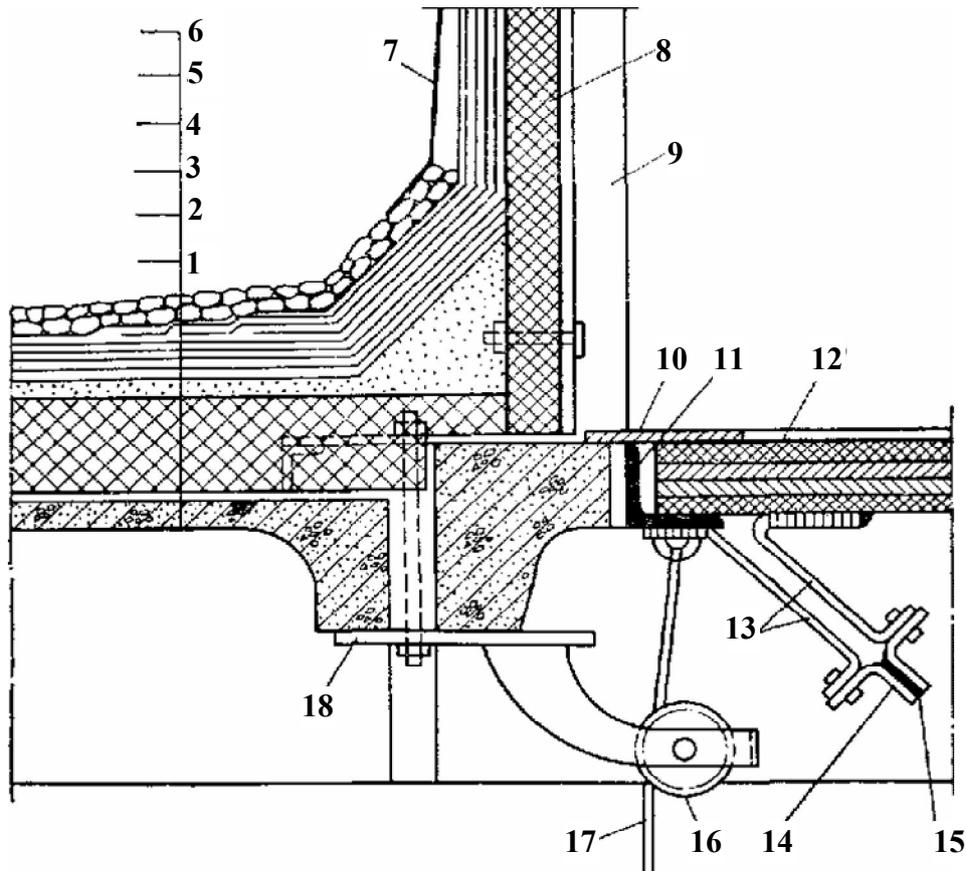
Деталь автоматичного пристрою: 1 – залізобетонна плита покриття; 2 – пароізоляція; 3 – утеплювач; 4 – шар, що вирівнює; 5 – покрівля; 6 – захисний шар; 7 – фартух з покрівельної сталі; 8 – заповнення каркаса шахти; 9 – каркас шахти; 10 – нащільник; 11 – рамка з кутиків; 12 – клапан; 13 – фасонні частини зі смугової сталі; 14 – кутики; 15 – легкоплавкий сплав; 16 – блок; 17 – трос; 18 – косинка або закладна деталь
